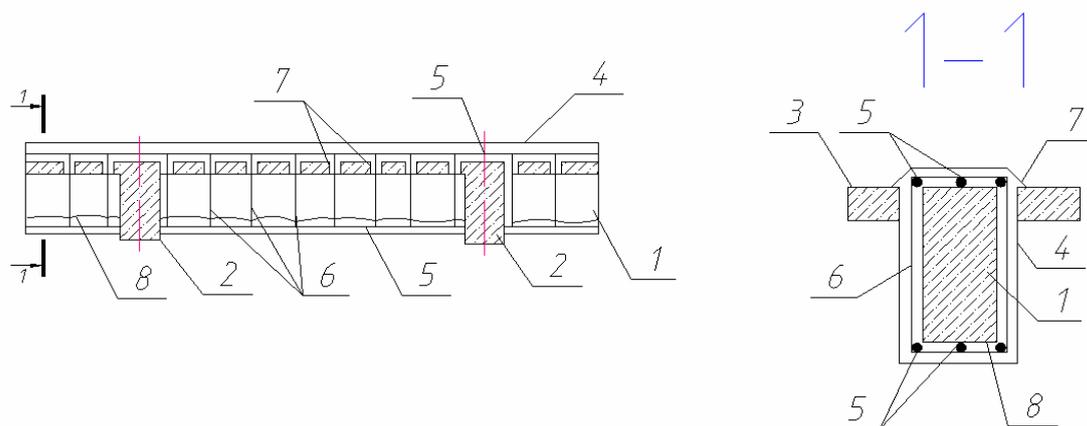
Усиление балок монолитного железобетонного перекрытия устройством железобетонной обоймы: 1 – усиливаемые второстепенные балки; 2 – главные балки; 3 – плита; 4 – железобетонная обойма; 5 – продольная арматура обоймы; 6 – хомуты обоймы; 7 – отверстия, просверленные в плите для пропуска хомутов и укладки бетона; 8 – поверхность балок, подготовленная к бетонированию
